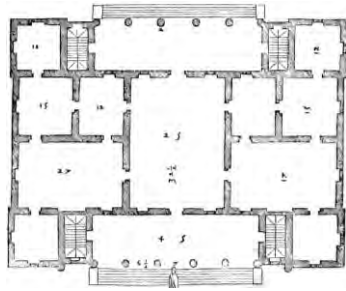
Pianta di Villa Valmarana, da "I Quattro Libri dell'Architettura"
